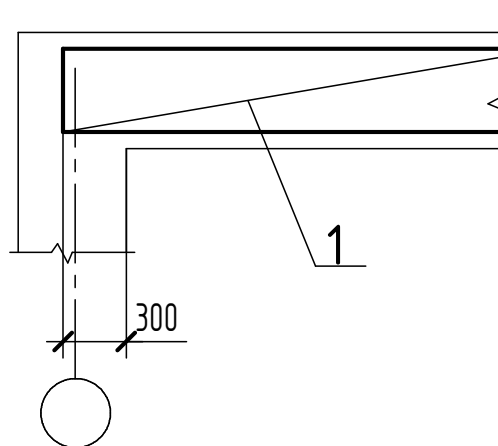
Условное изображение каркаса или сетки на схеме армирования
